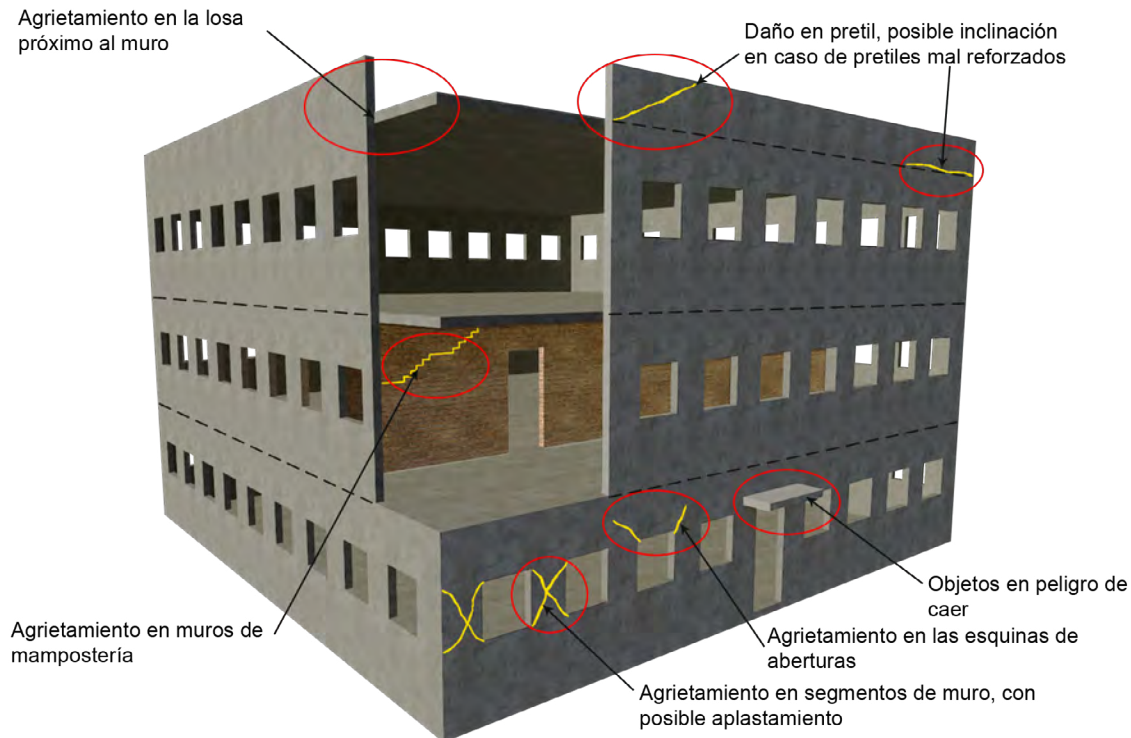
Zonas dañadas comúnmente encontradas en edificios a base de muros de concreto.
